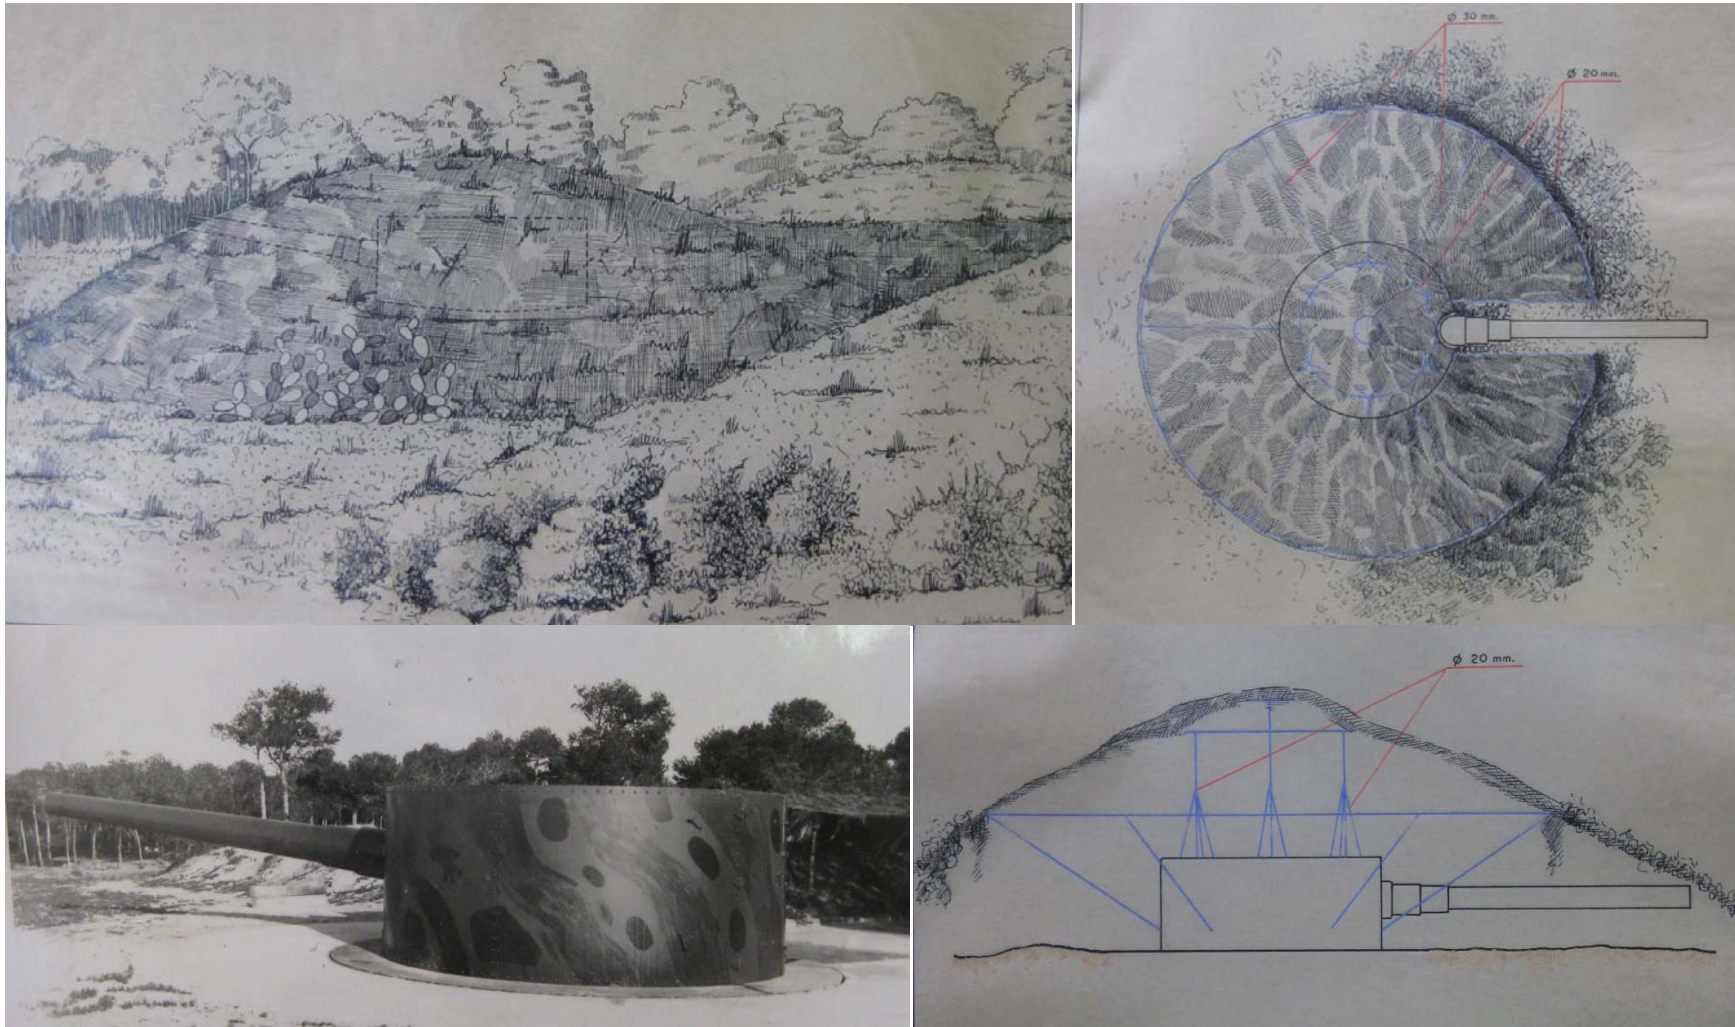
Fotografía pieza Guillén, incluida en el proyecto de enmascaramiento. Imagen 6.56 Perspectiva, planta y sección del proyecto.
